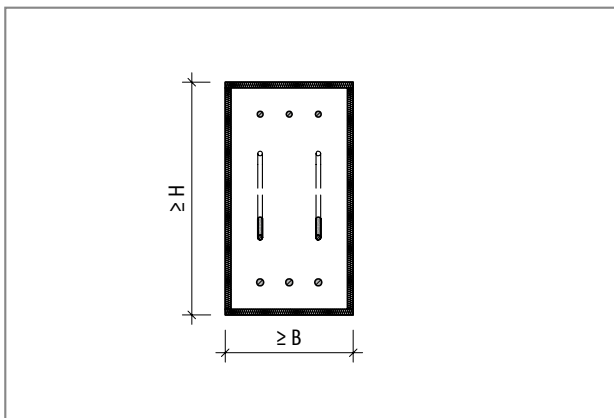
Schöck Isokorb® tipo S R90, rivestito in stabilimento con elementi antincendio
